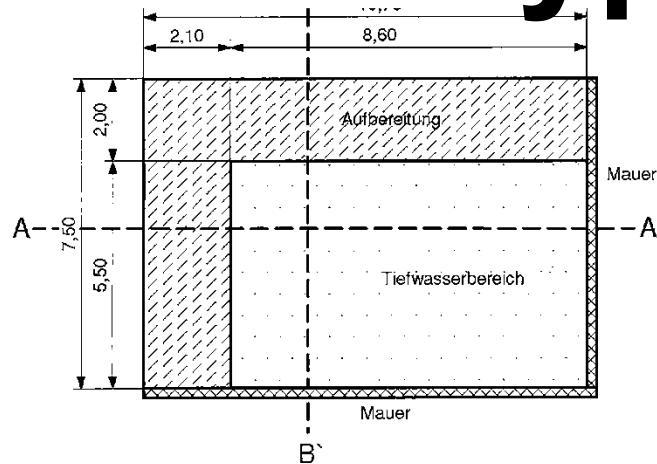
Prinzipskizze – Schwimmteichtyp II „Einkammersystem mit Oberflächenströmung“ (alle Maße in Metern)
